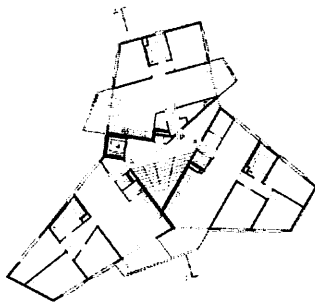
F₁地区 星形平面図 文献〔1〕139頁
